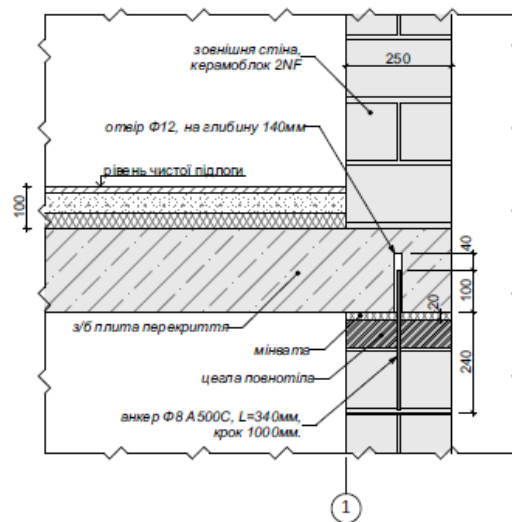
Вузол кріплення мурування стін до плити перекриття
